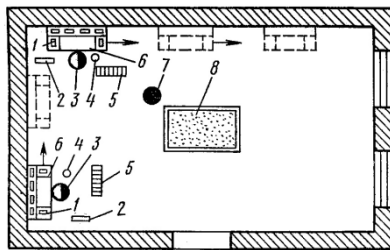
Схема организации рабочего места при производстве облицовочных работ внутри помещения:
